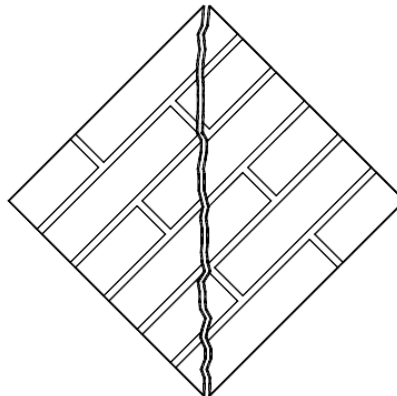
Ensayo a compresión diagonal en muretes de mampostería
